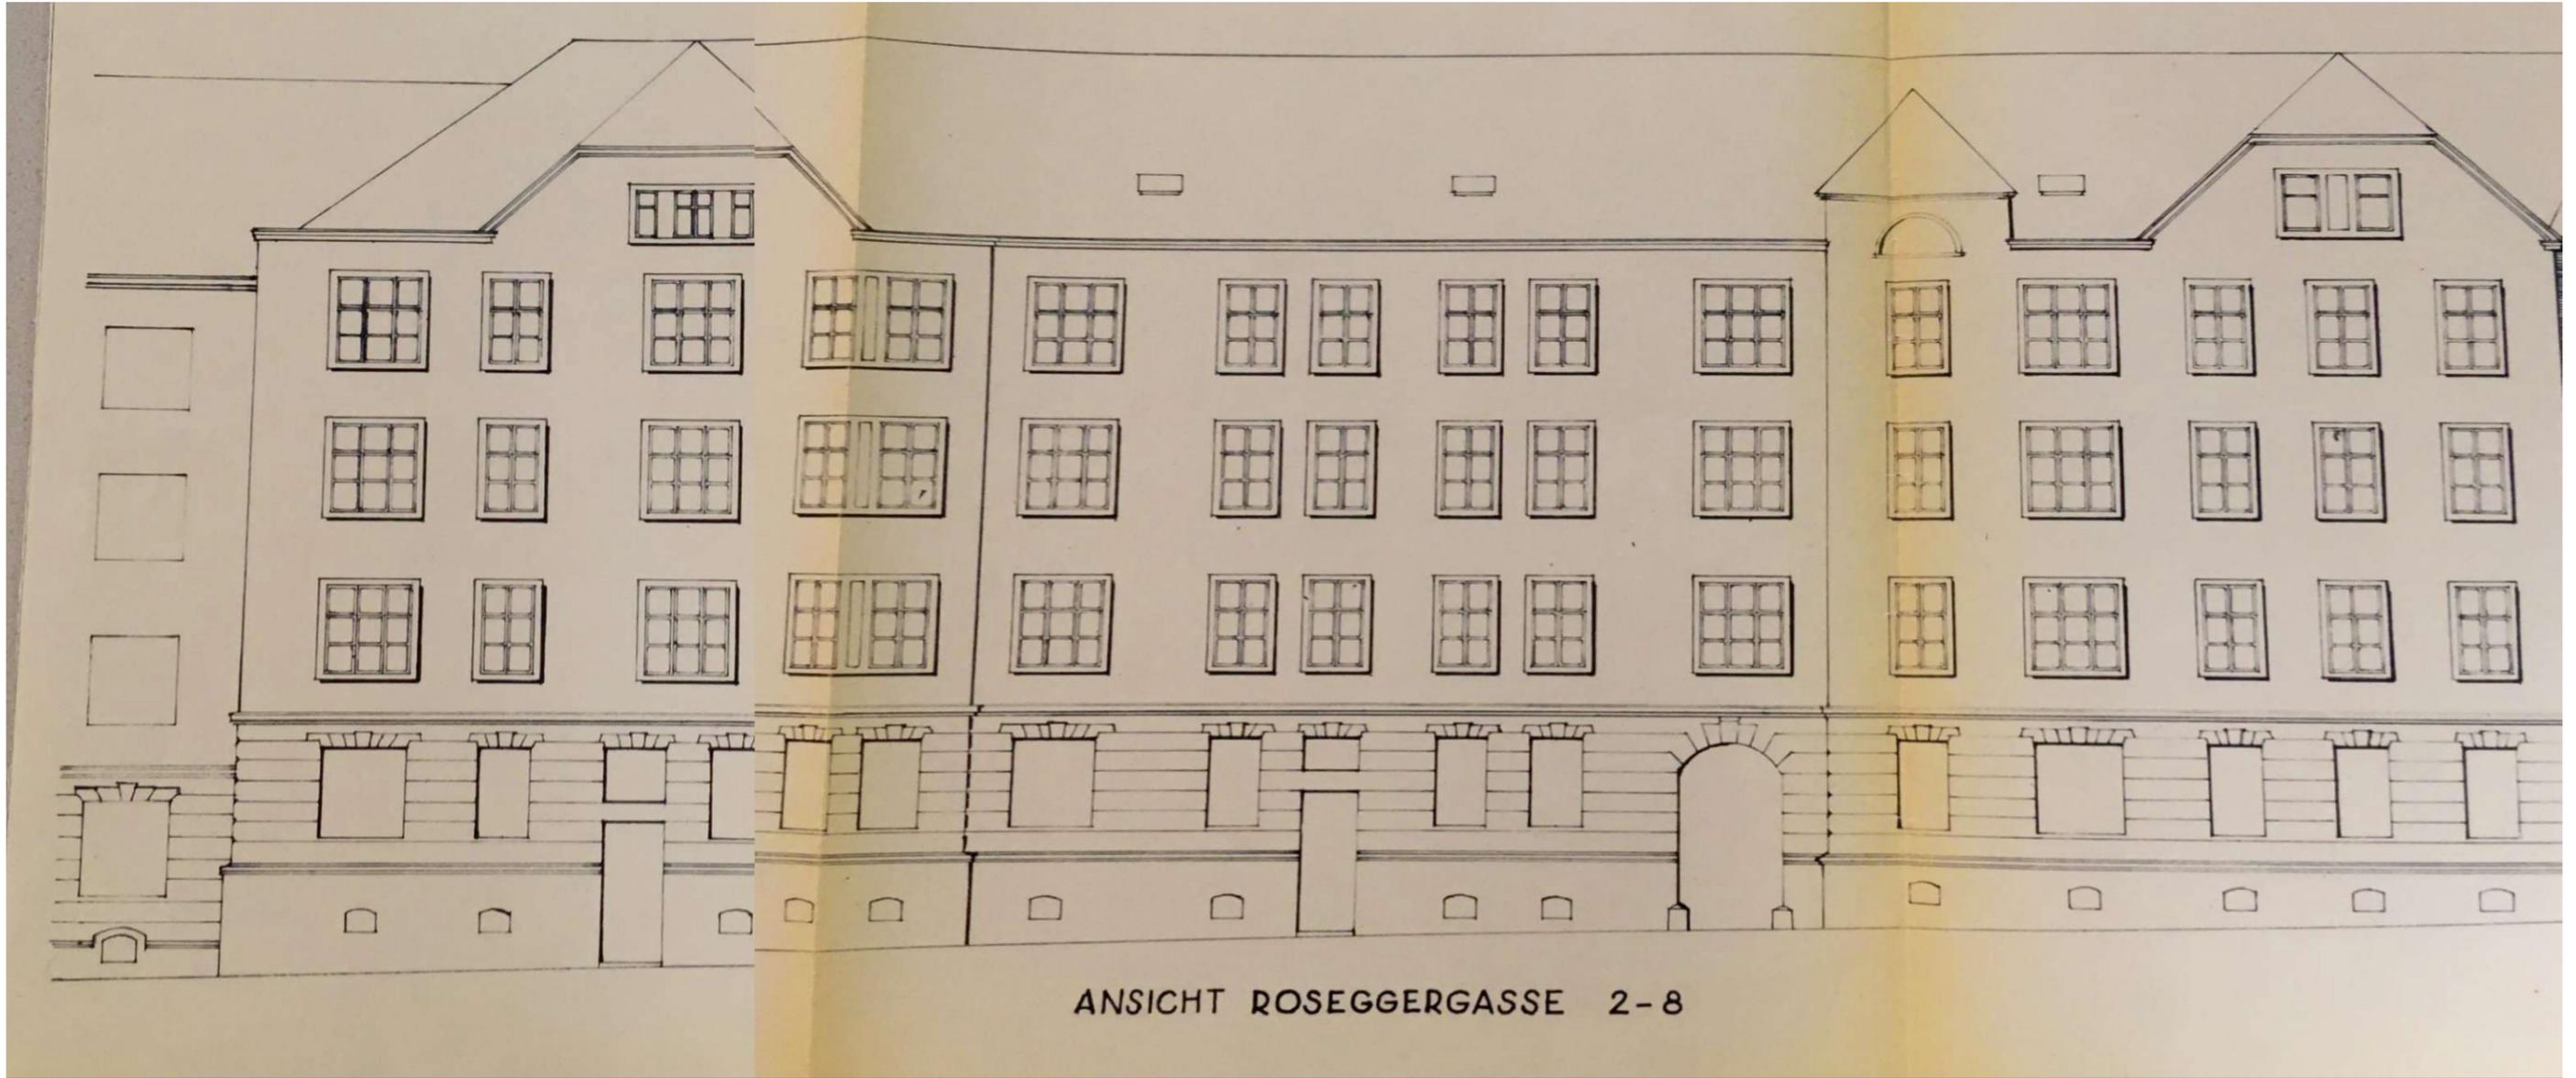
Planarchiv MA37, Sanierung der Fassade im Jahr 1975
